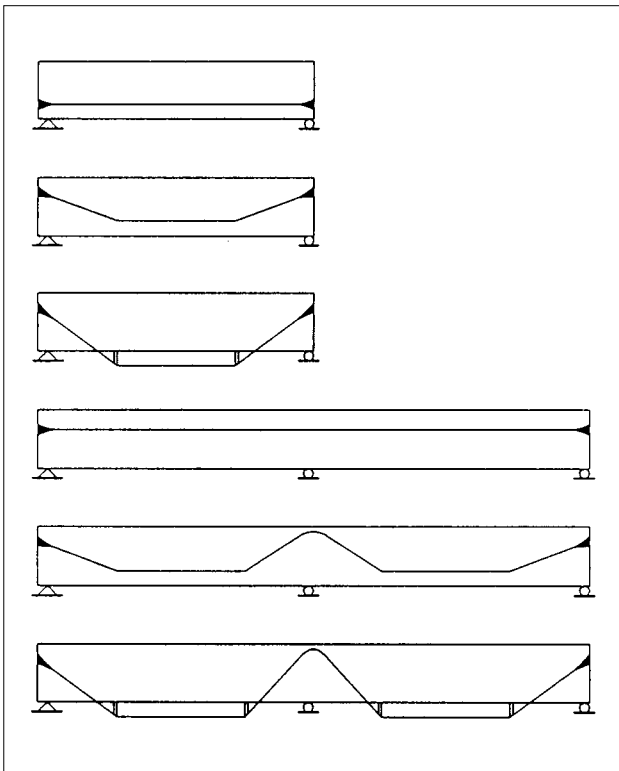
Dispositions possibles des câbles dans le sens longitudinal de la poutre.
